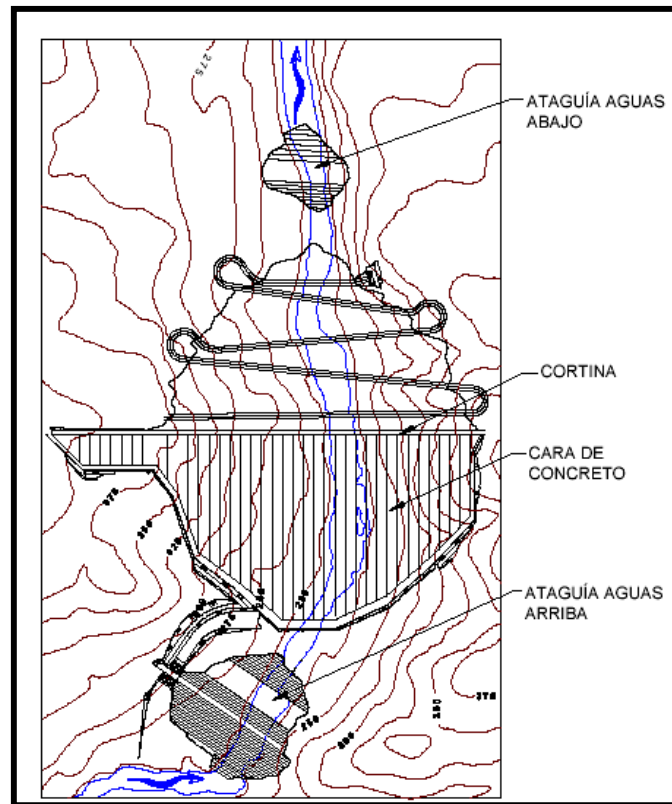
Planta de la cortina de enrocamiento con cara de concreto. Nótese la disposición de las estructuras aledañas
